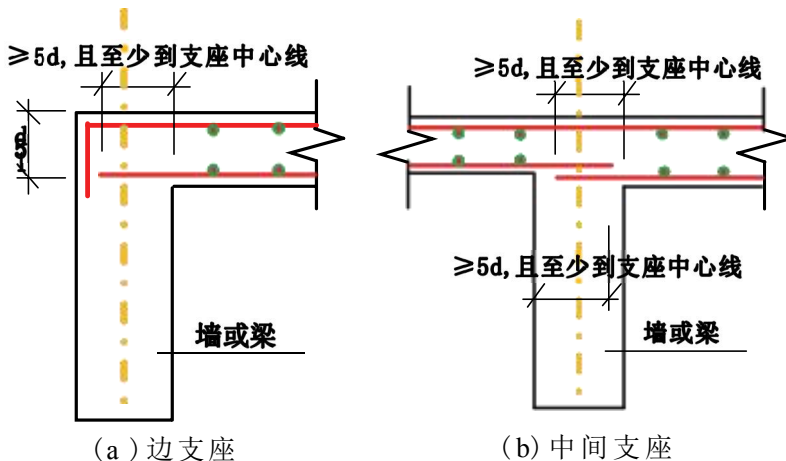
楼板 M 型钢骨架在支座处构造示意
